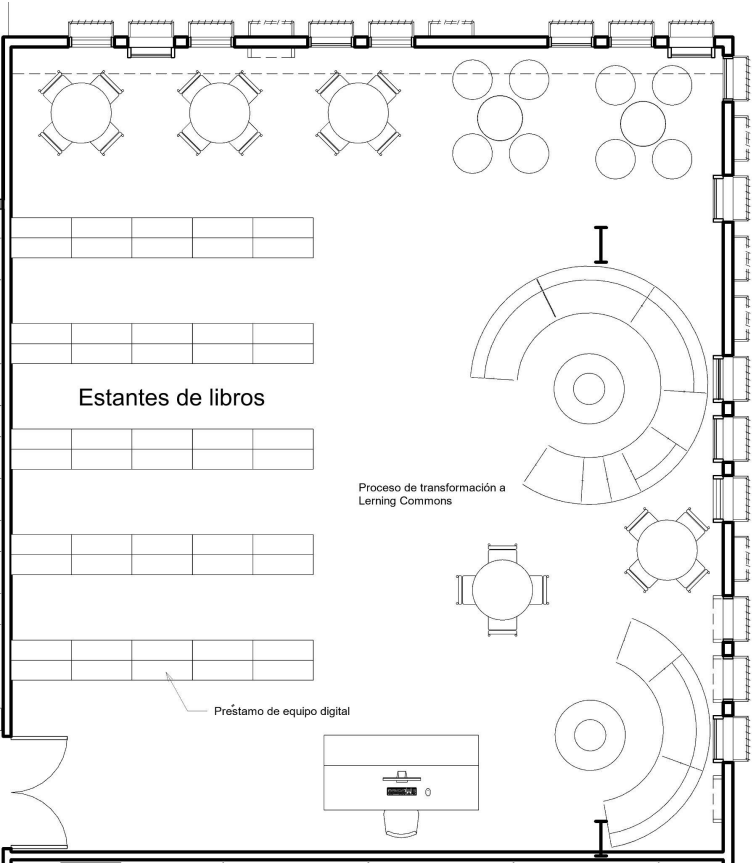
Detalle planta de biblioteca. Fuente propia.
